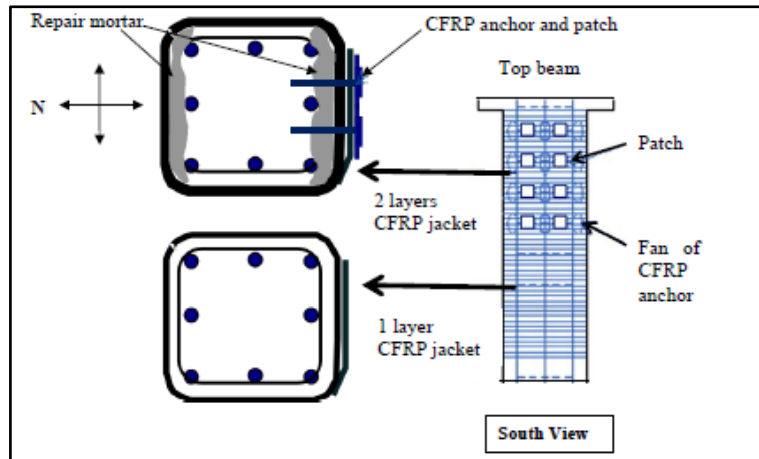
Detalles para el Reforzamiento de la parte Superior de la Columna.
